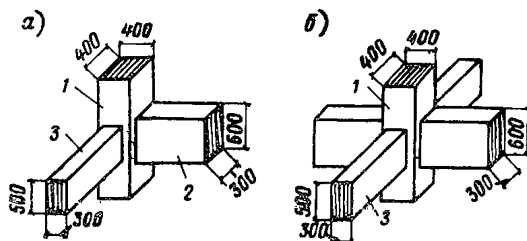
Крайний (а) и средний (б) узлы рамы с бесконсольным опиранием ригелей на колонны
